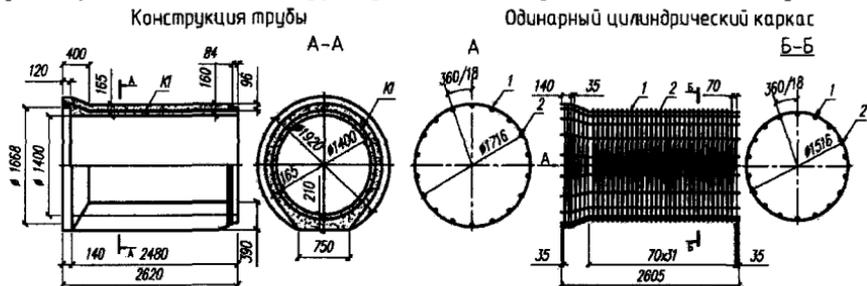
Испытываемая конструкция безнапорной железобетонной трубы большого диаметра, армированная одинарным цилиндрическим каркасом
